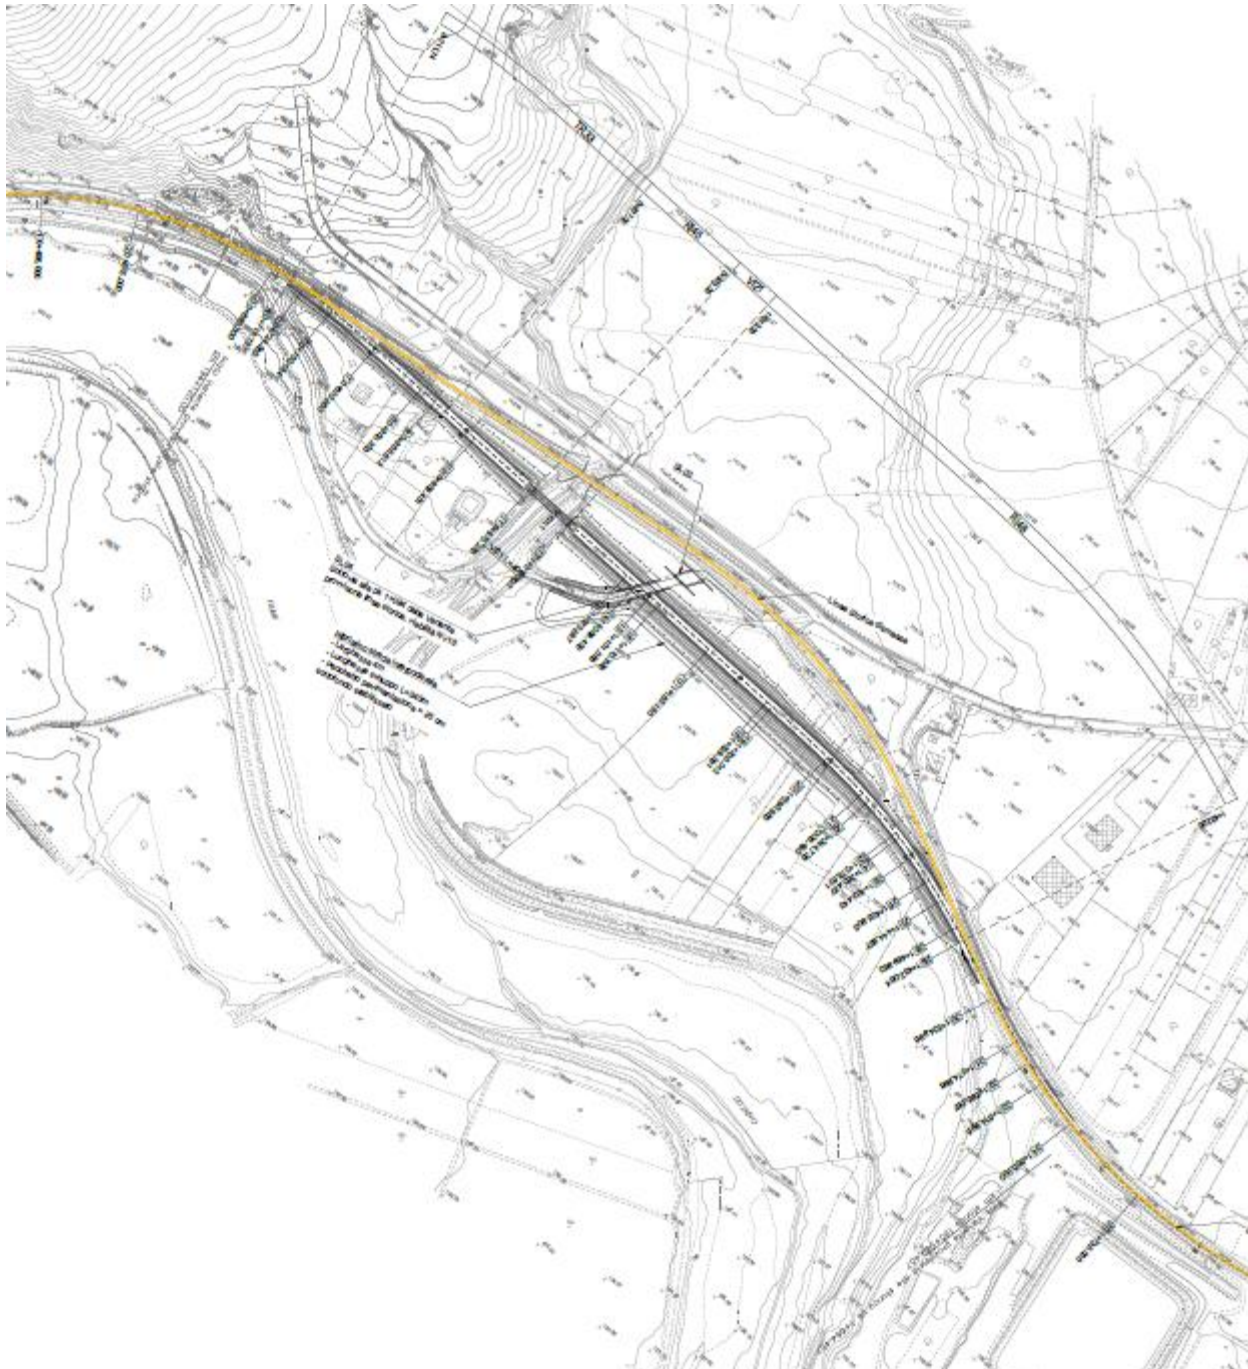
Stralcio planimetrico Variante Provvisoria alla Linea Storica al km 194+120
